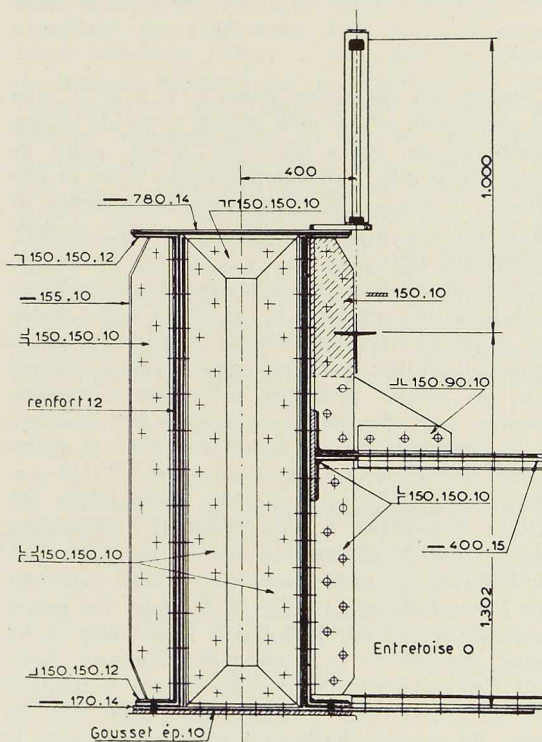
Coupe dans un about de maîtrepoutre Viereendeel, en encorbellement dans la travée latérale (console en caisson).
